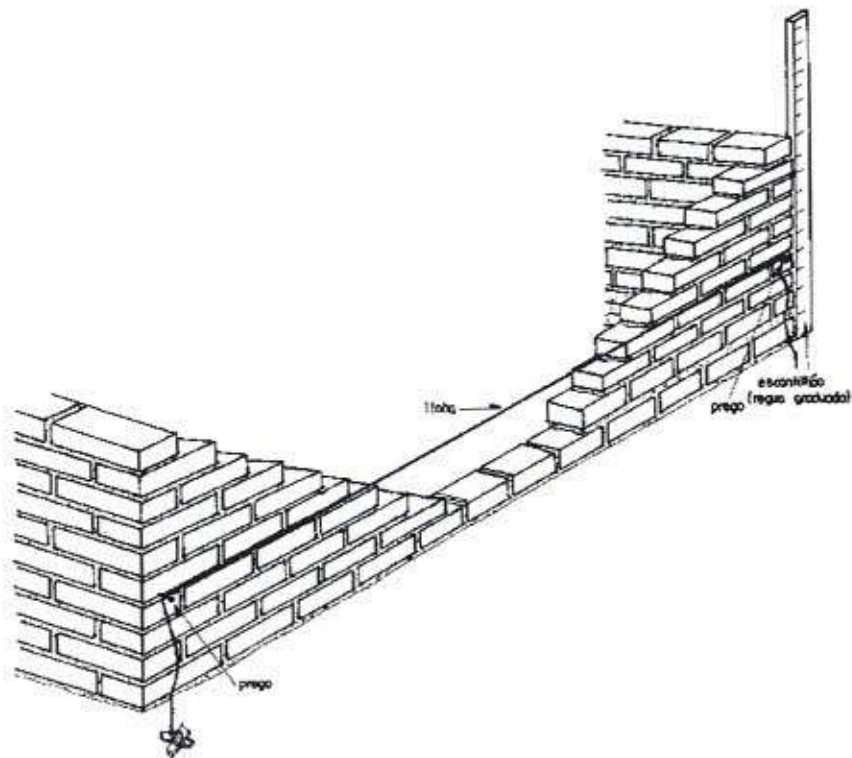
Detalhe do nivelamento da elevação da alvenaria.
